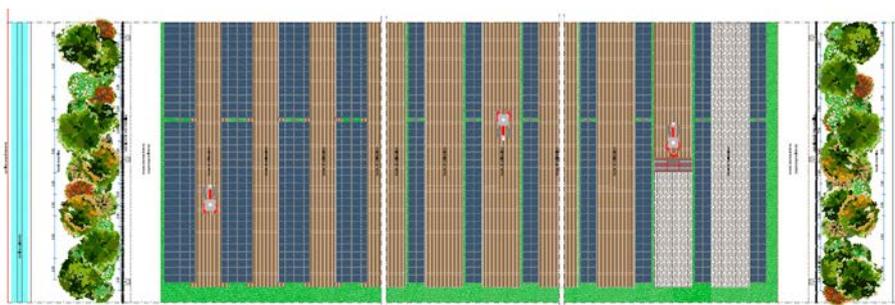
Fasce di coltivazione con i pannelli. Pianta - Stralcio
